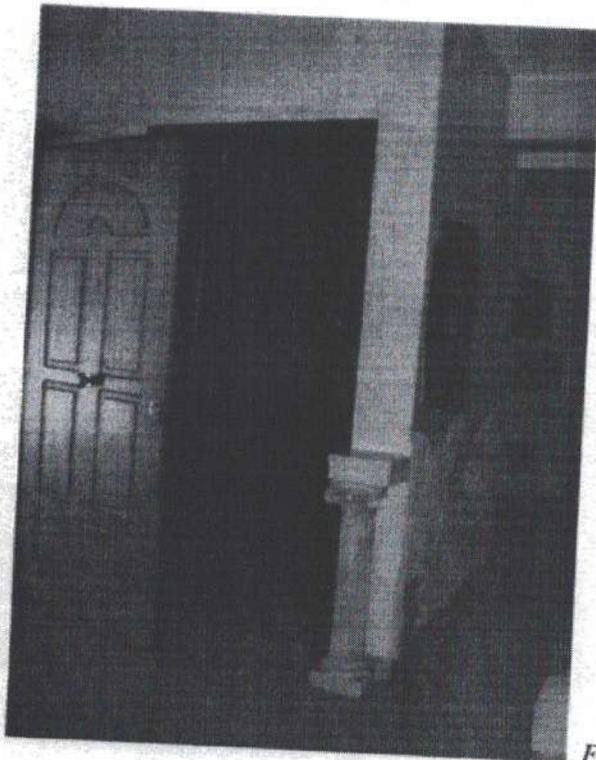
prospetto est con ingressi al fabbricato
